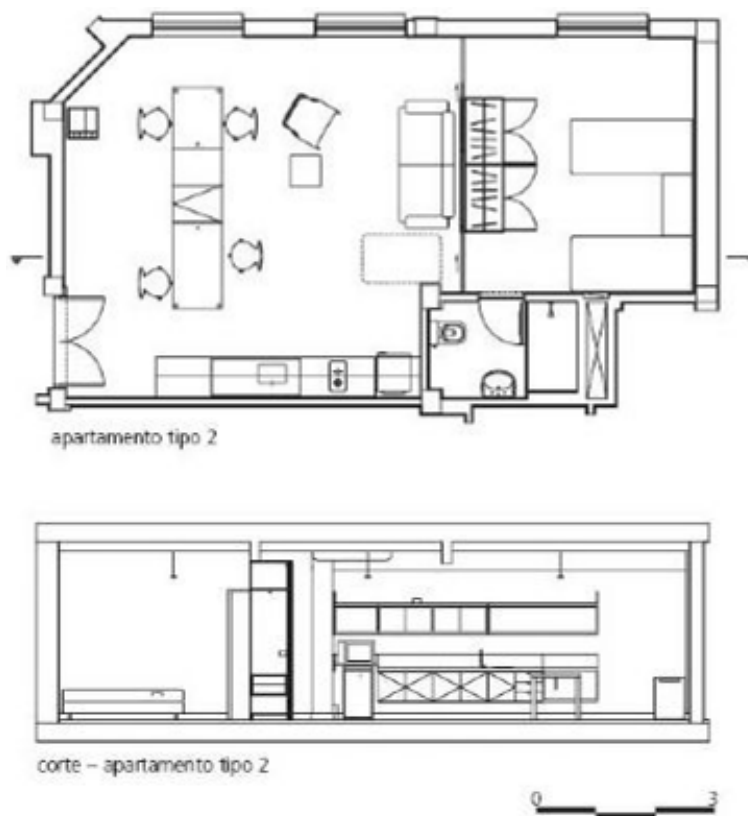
PLANTA E CORTE DO LOFT TIPO 2
